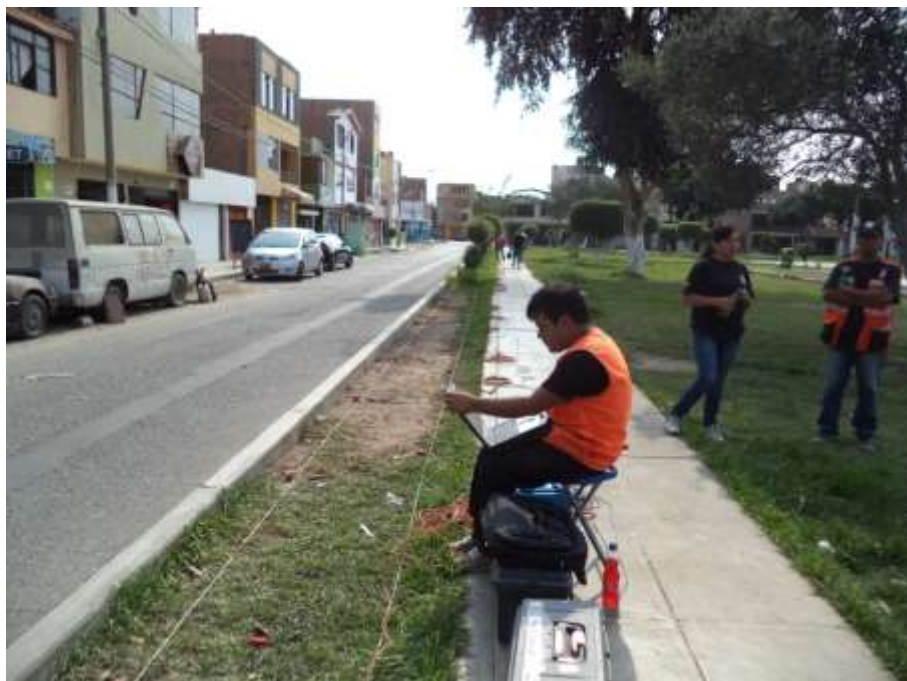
MASW-07. Se observa el arreglo lineal de los geófonos y su conexión con los cables para la ejecución del ensayo MASW.
